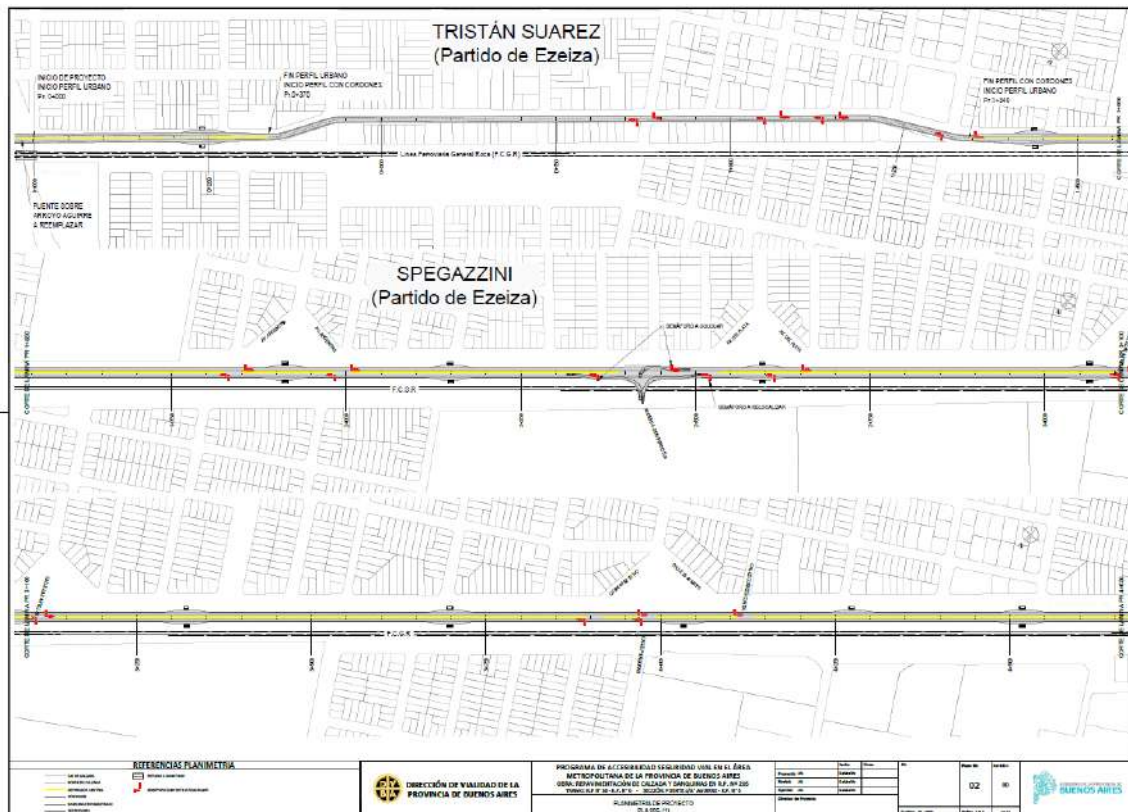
Planimetría de Proyecto RPN°205 (1)
